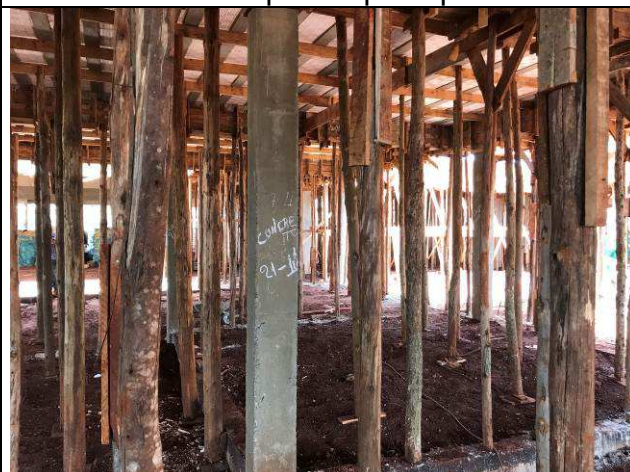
C: Pilares concretados do prédio principal - eixos 6-10 e D-F.
